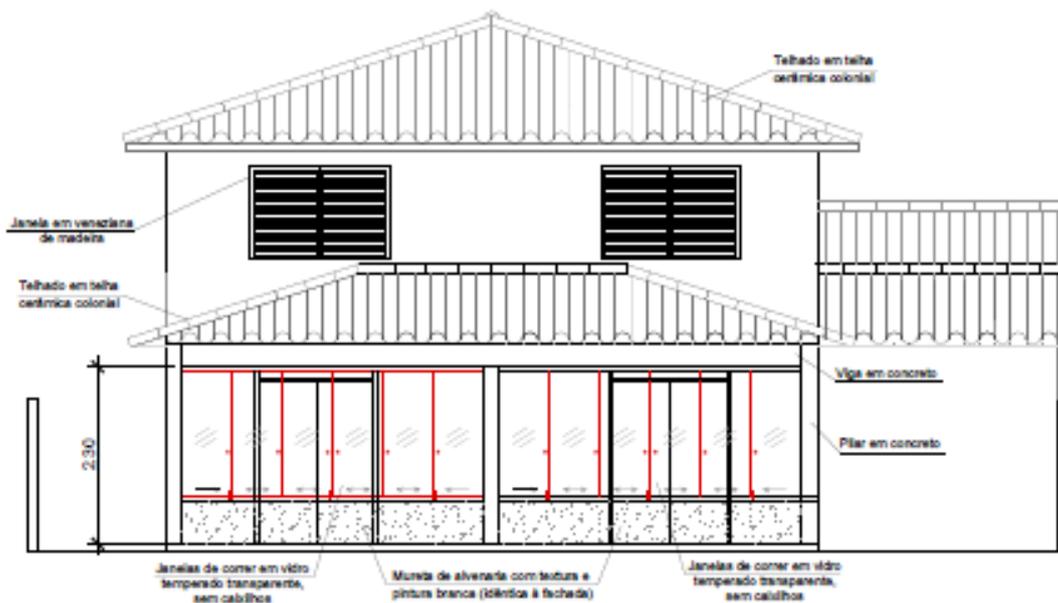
FACHADA FRONTAL- VARANDA E FECHAMENTO A SER INSTALADO
